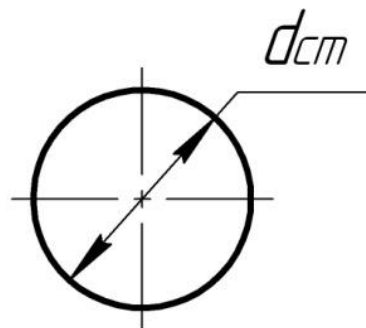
Схематичне зображення поперечного перерізу стояка
